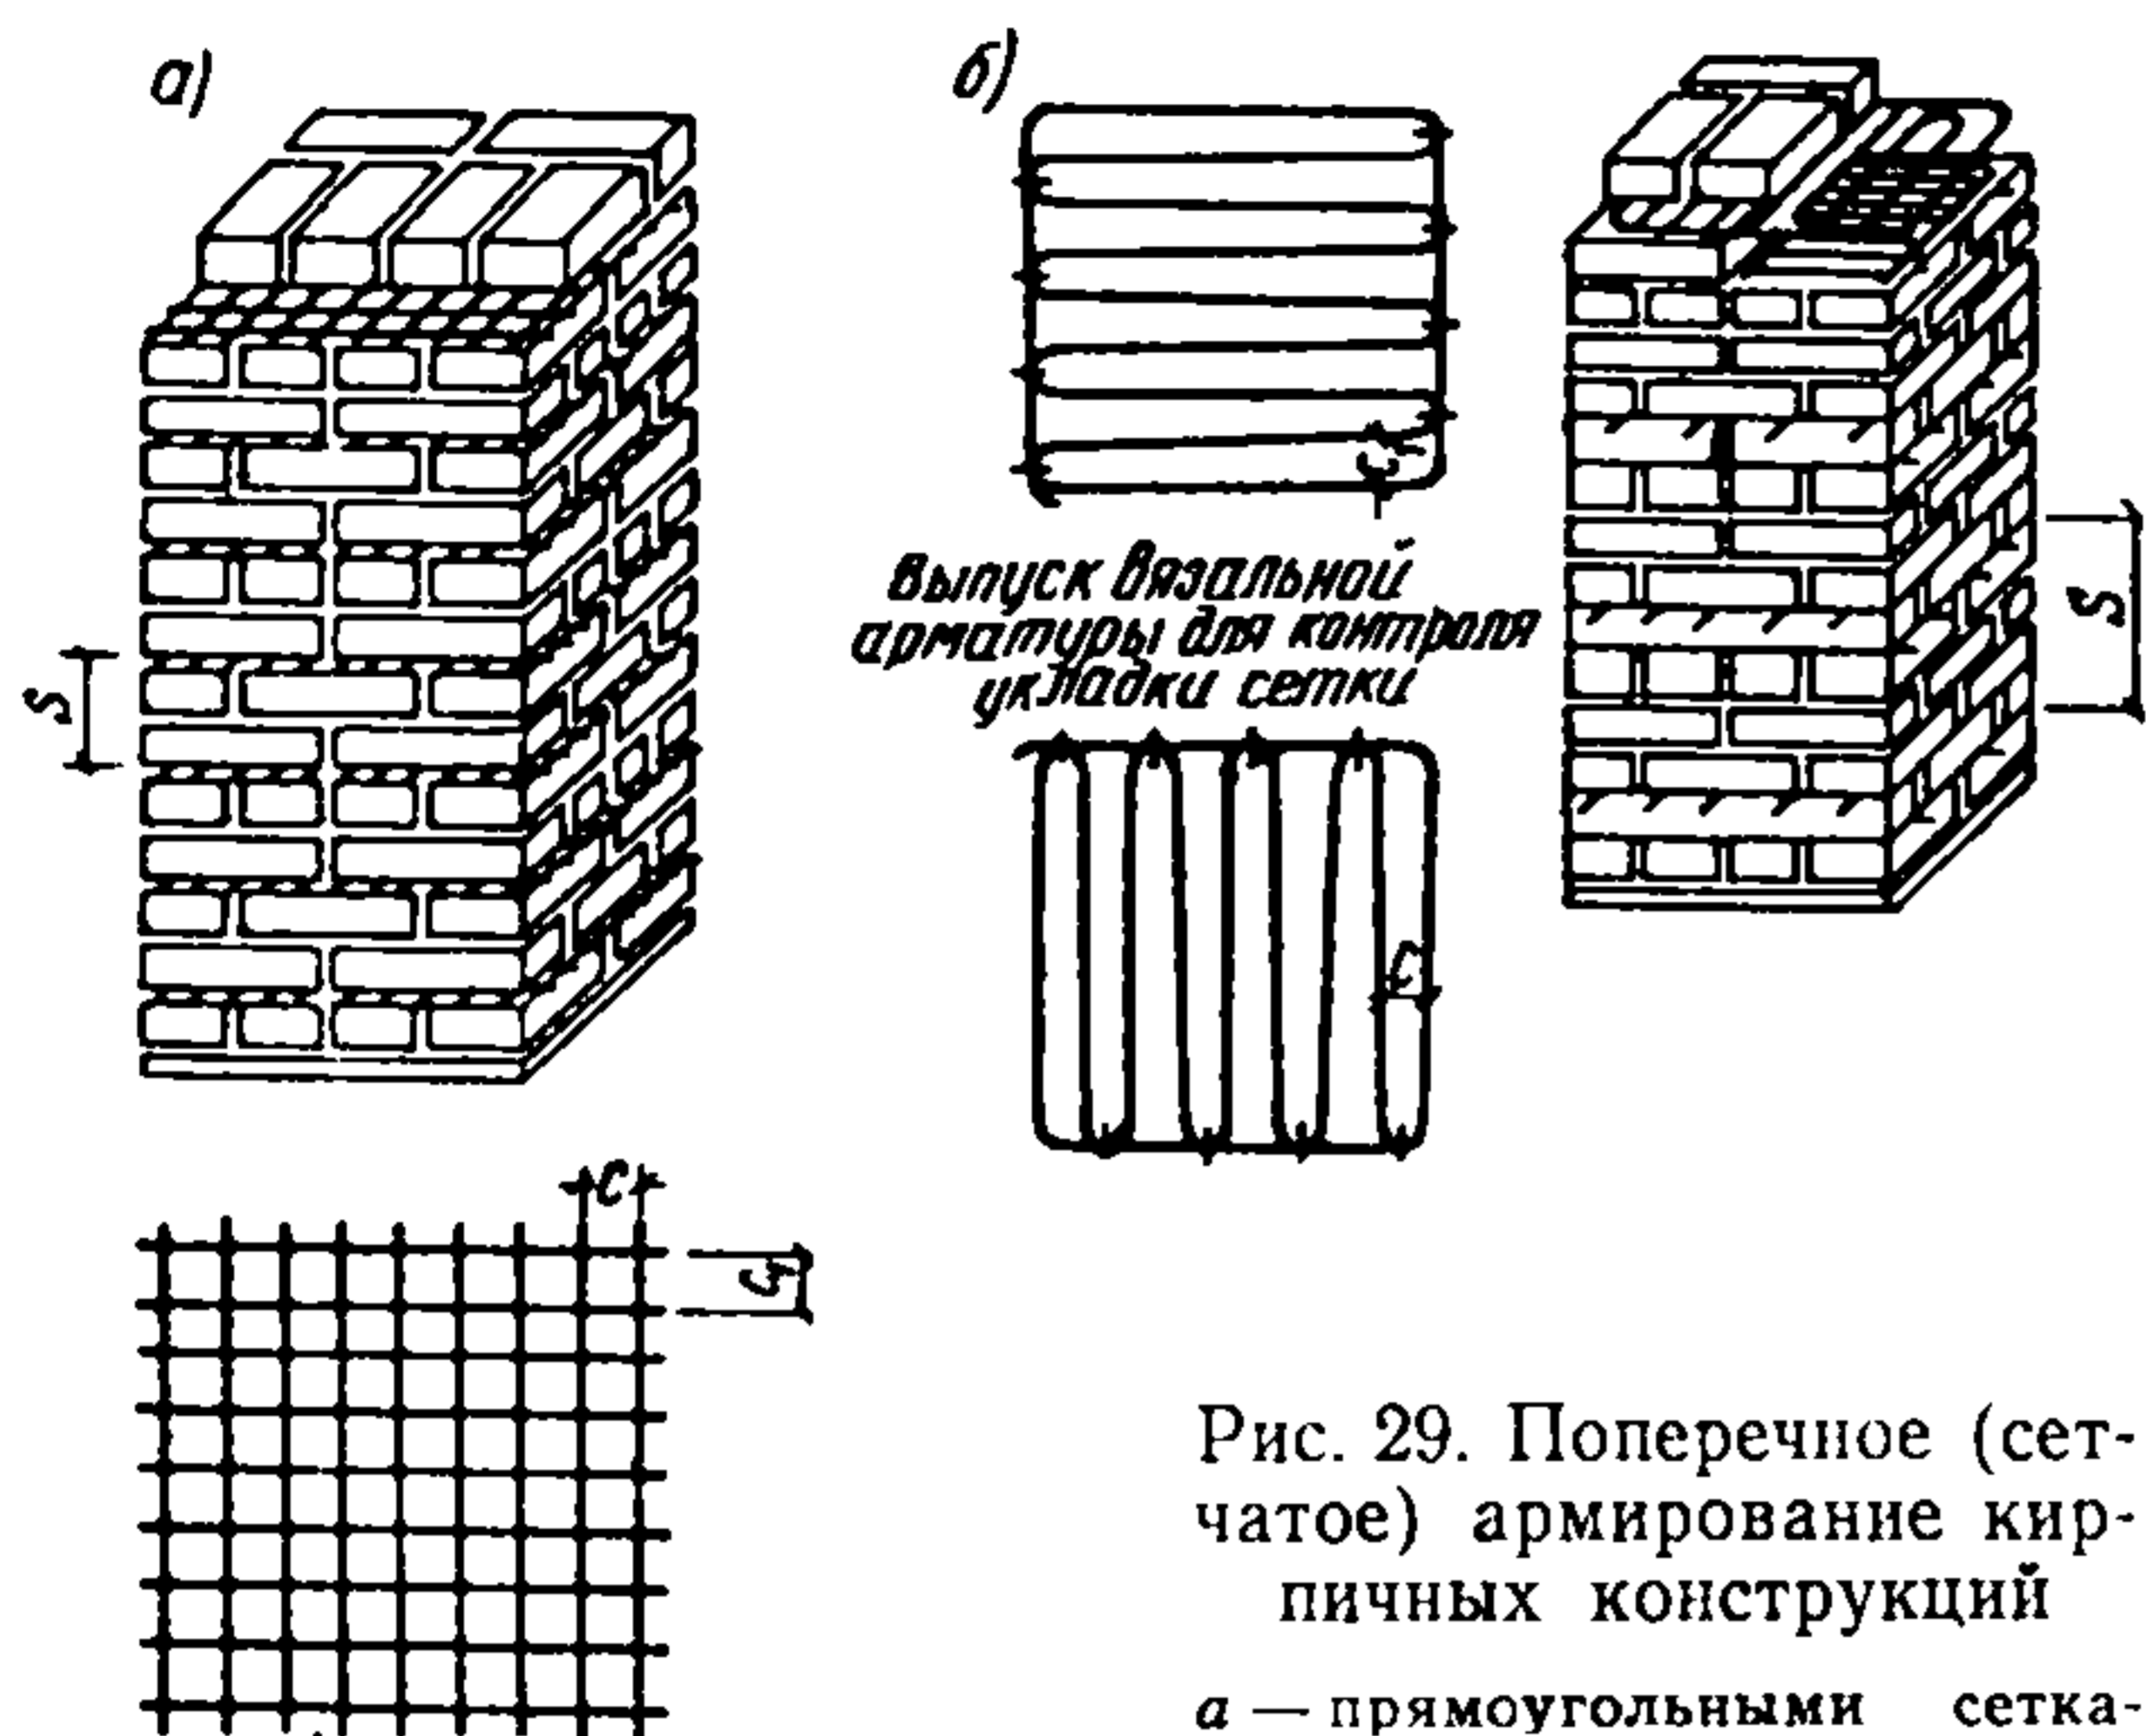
Поперечное (сетчатое) армирование кирпичных конструкций
